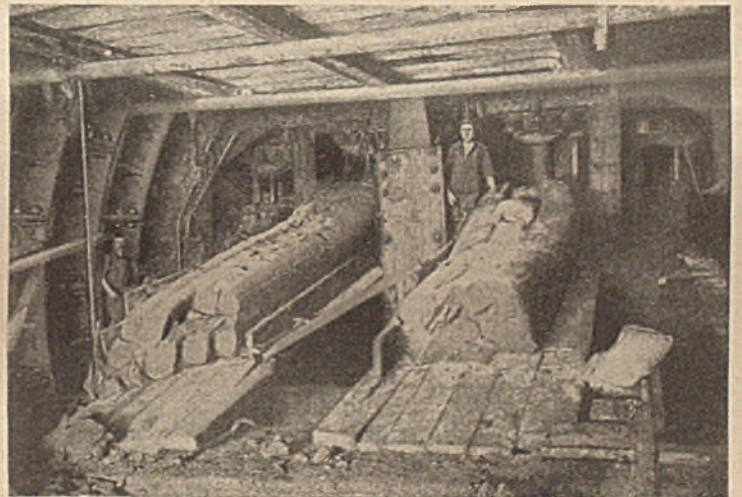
Eindringen des Schlammbodens durch die unteren Schildöffnungen.
